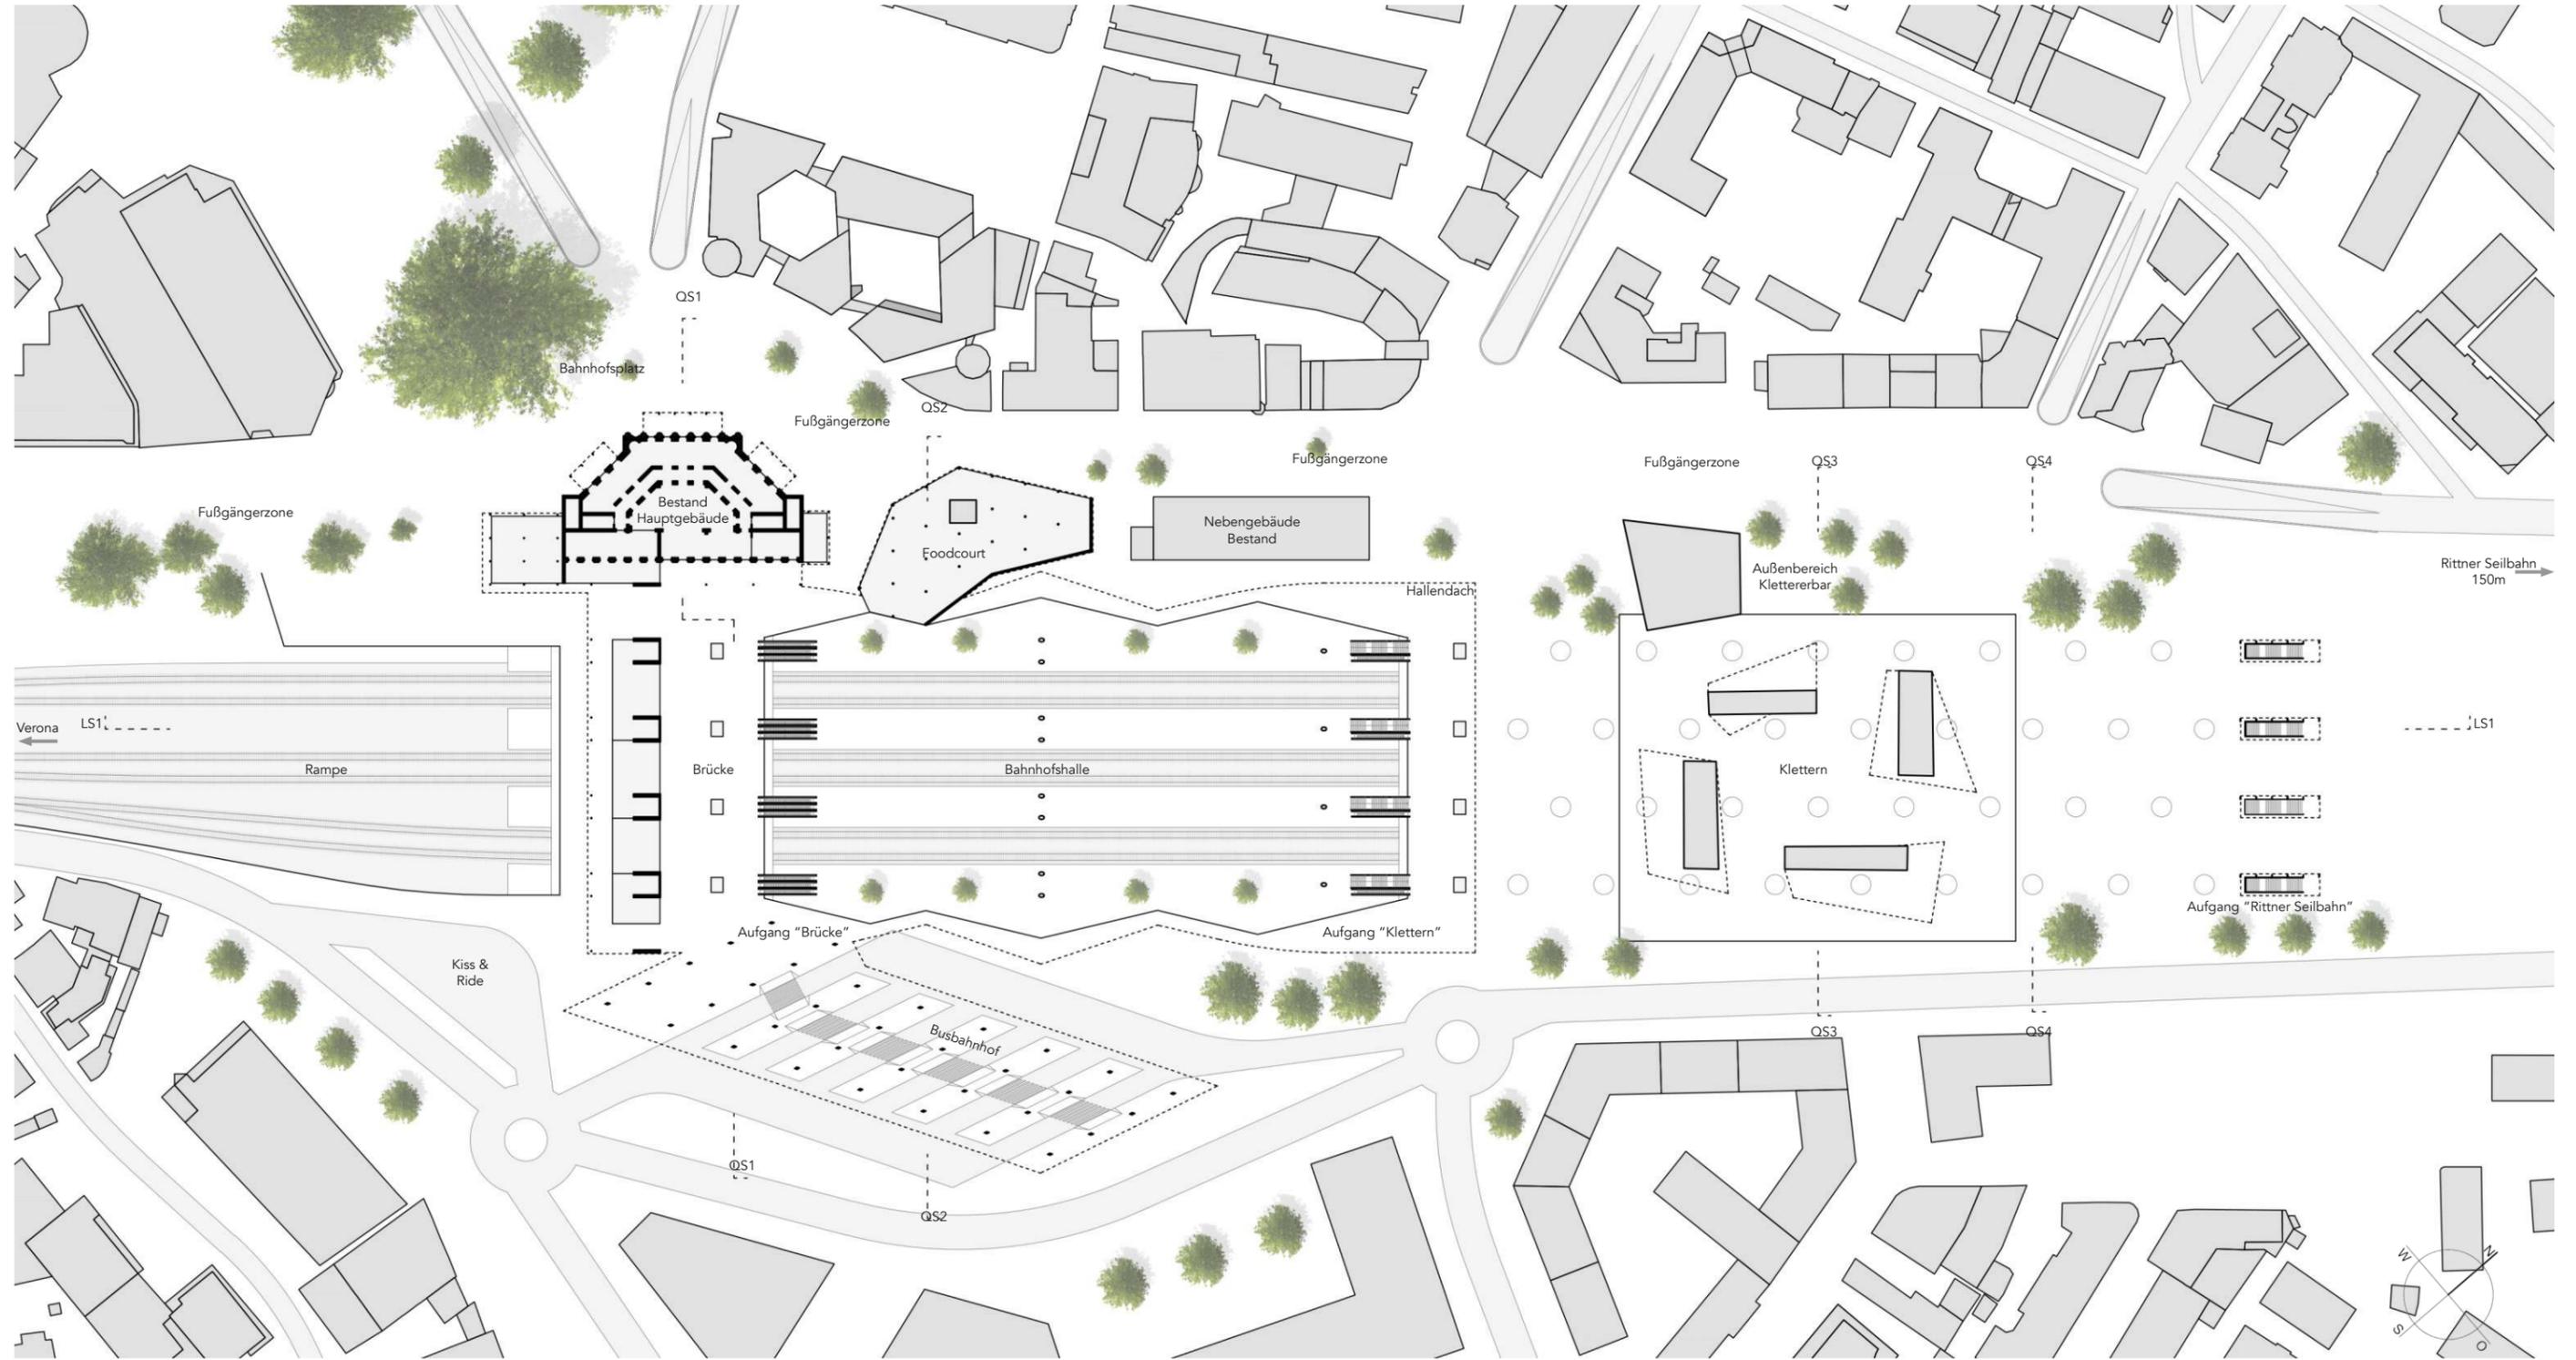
Grundriss Erdgeschoss 1:1500
